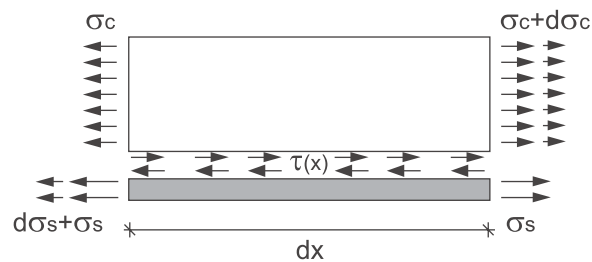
Differenzielles Stabelement für Stahlbeton
